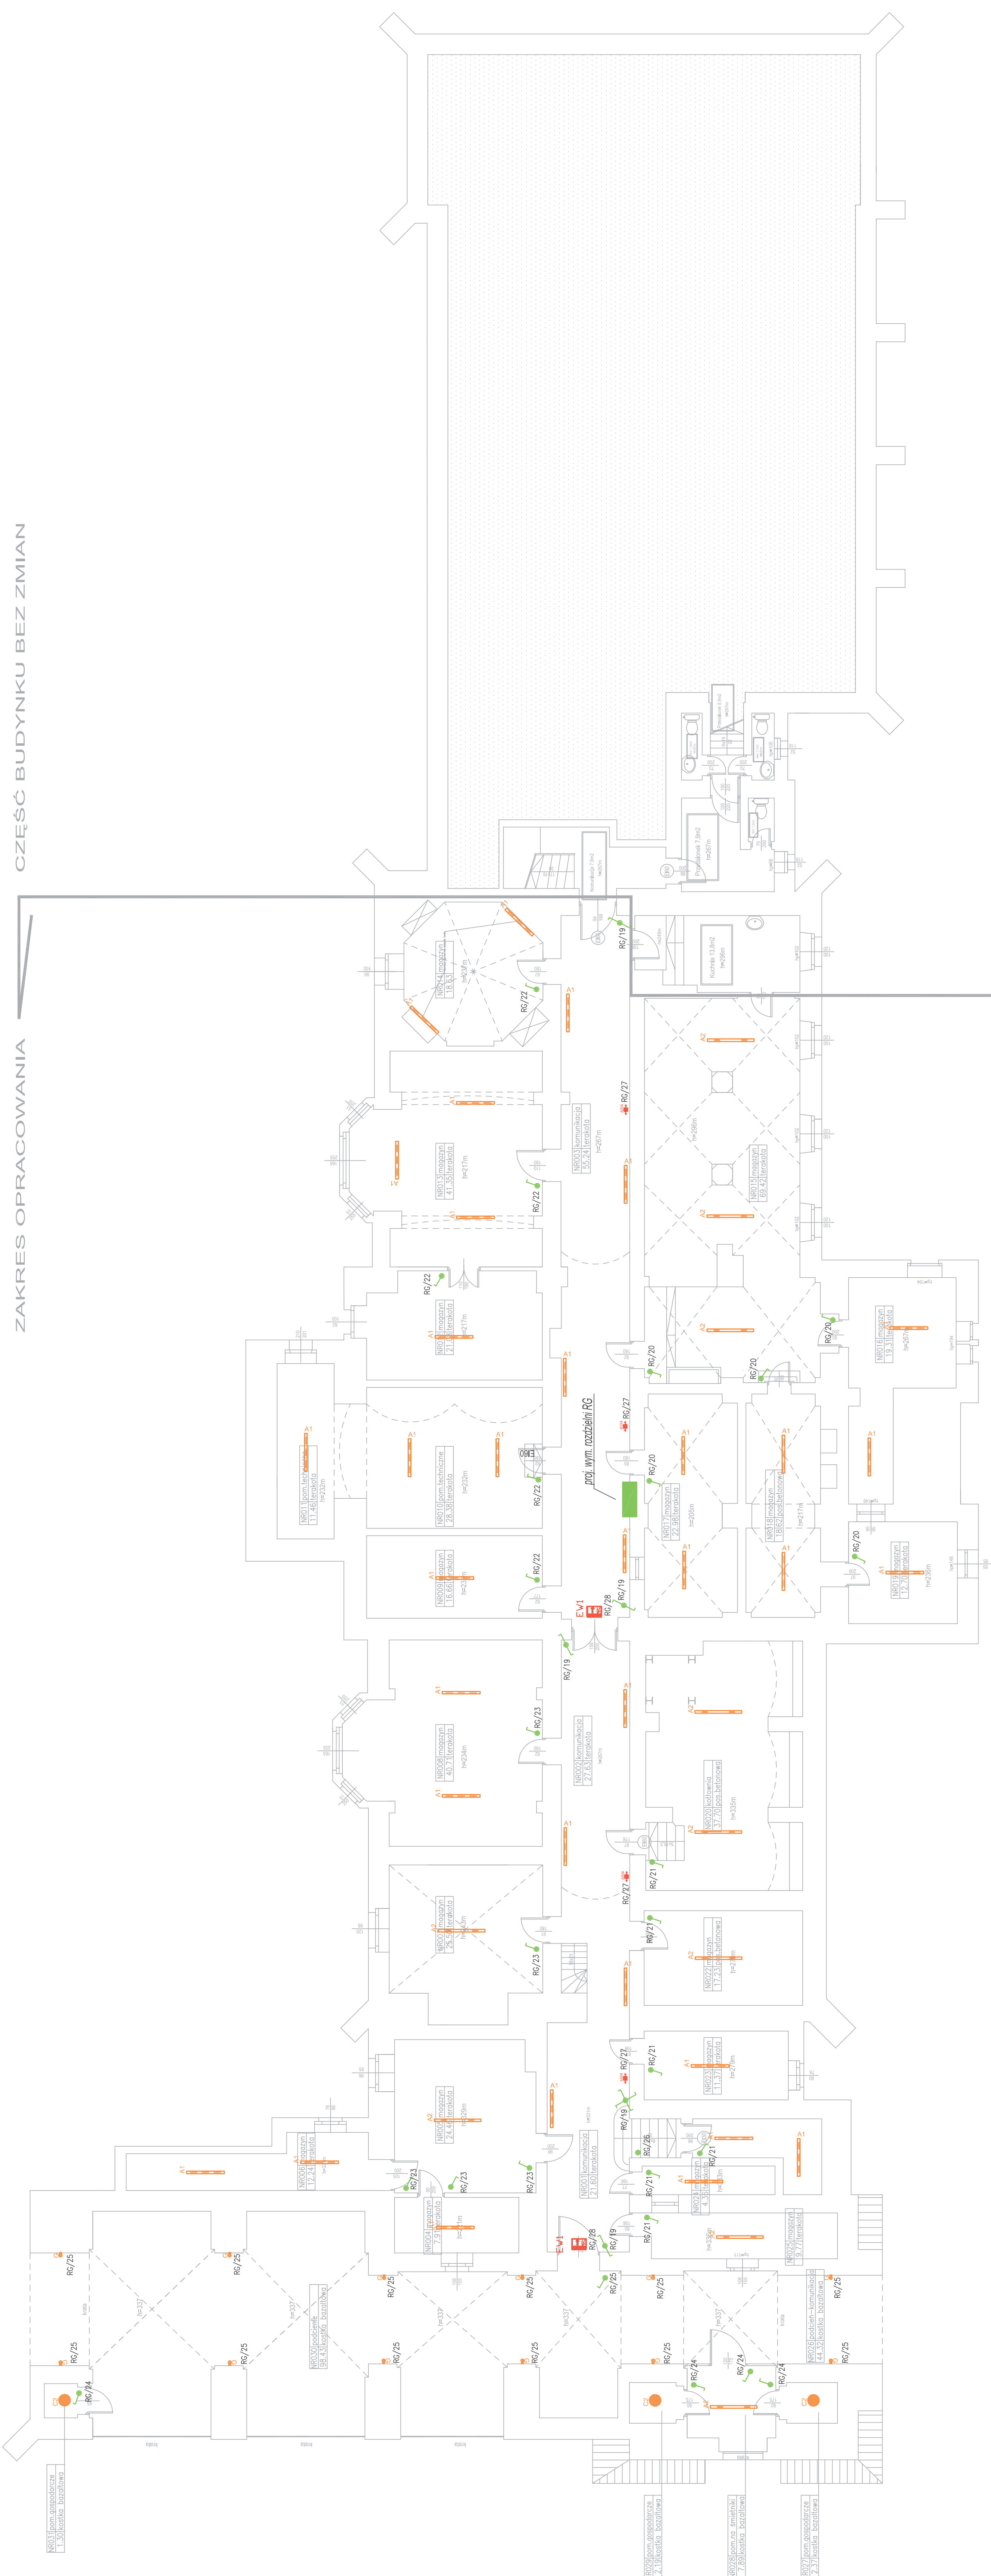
RZUT PIWNIC – INSTALACJA WEWNĘTRZNA	1:100
